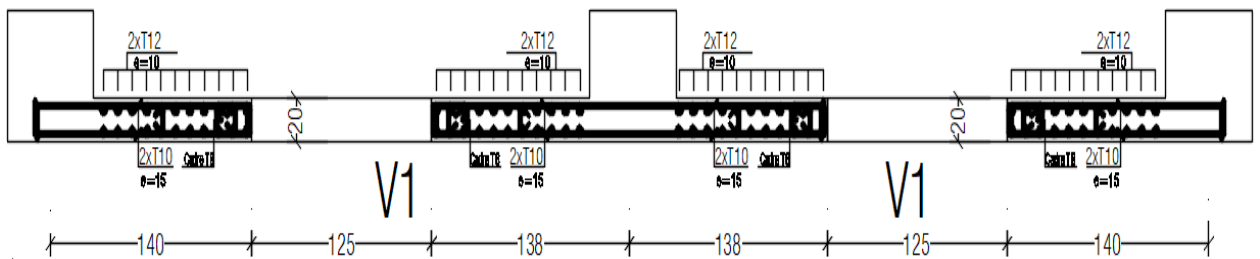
Schéma de Ferrailage de voile 1 (Zone 1,2 et 3).
